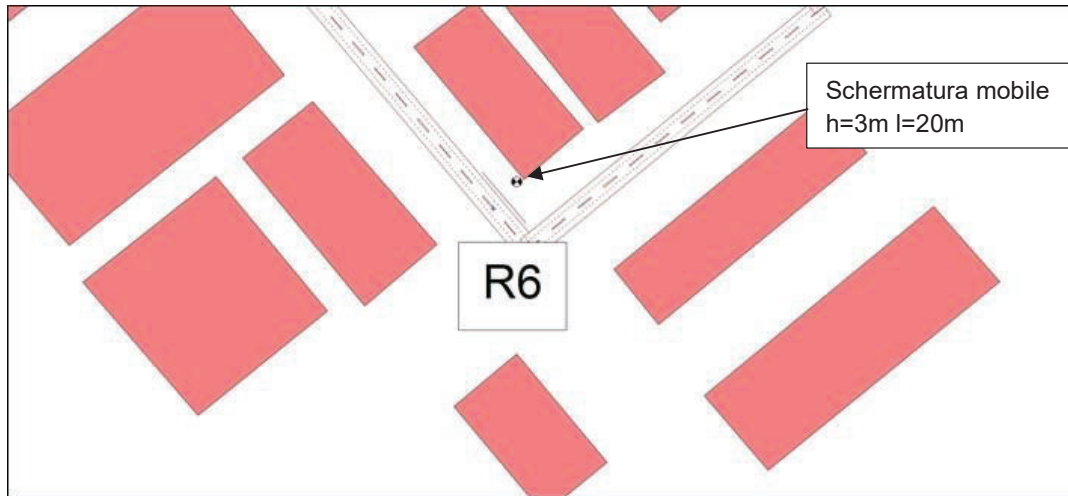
Schermature provvisorie per cantiere posa linea elettrica
